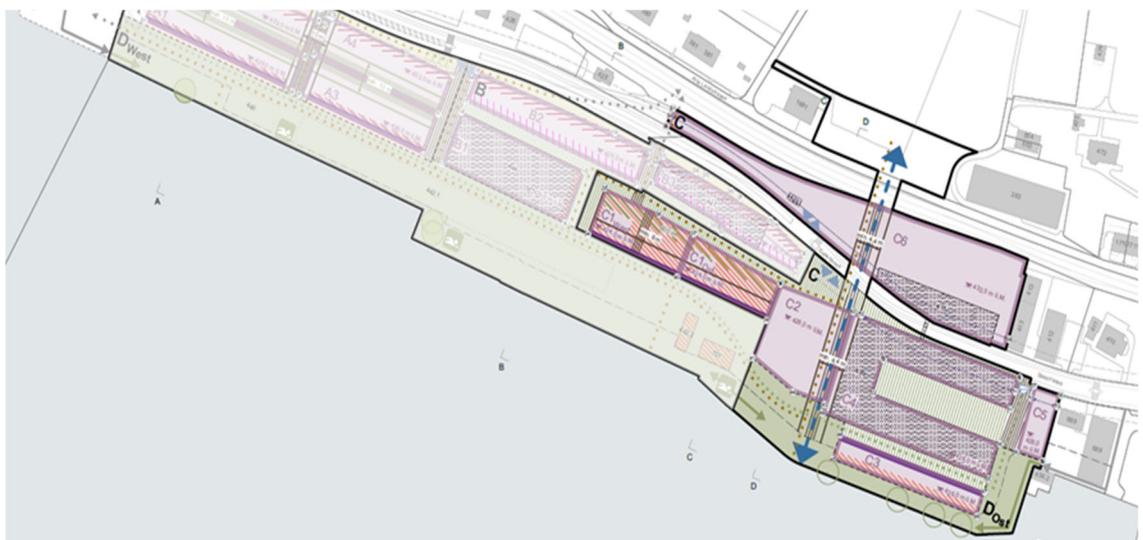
, Situationsplan öffentlicher kantonalen Gestaltungsplan.
